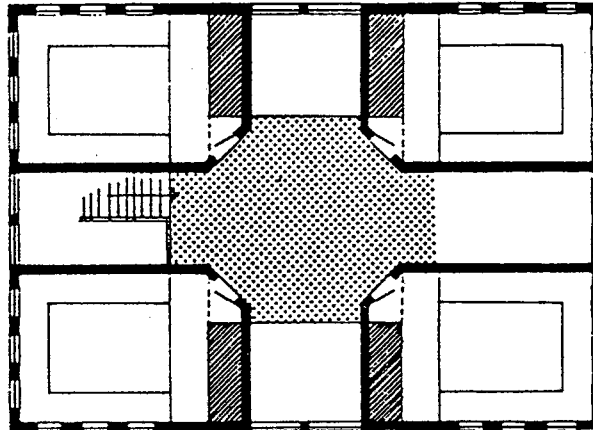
Sofasız plan tipleri ( Eldem, 1968)
